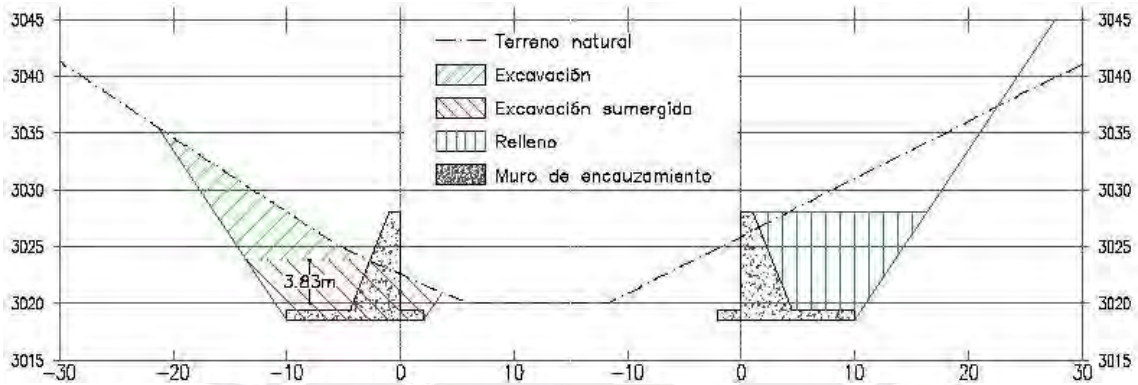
Sección típica de corte y relleno para muros de encauzamiento. Fuente: Elaboración propia.
